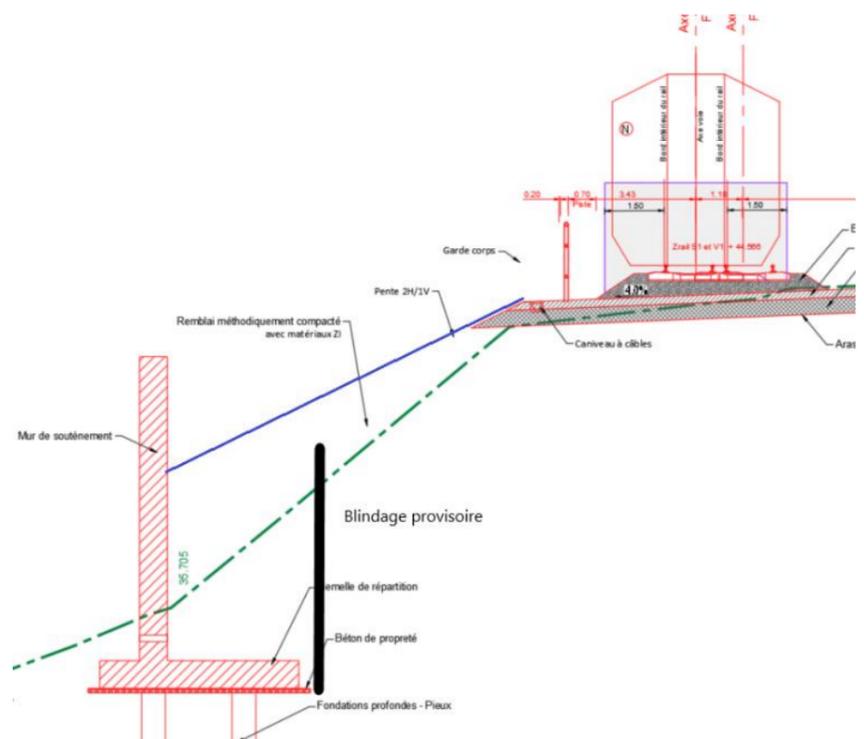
Mur de soutènement type (Source : Systra, 2021)
